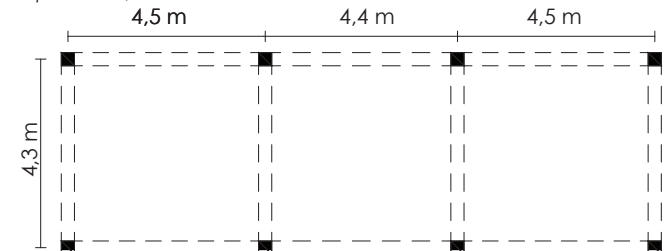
Pianta della campata strutturale; Fonte: elaborazione personale;
